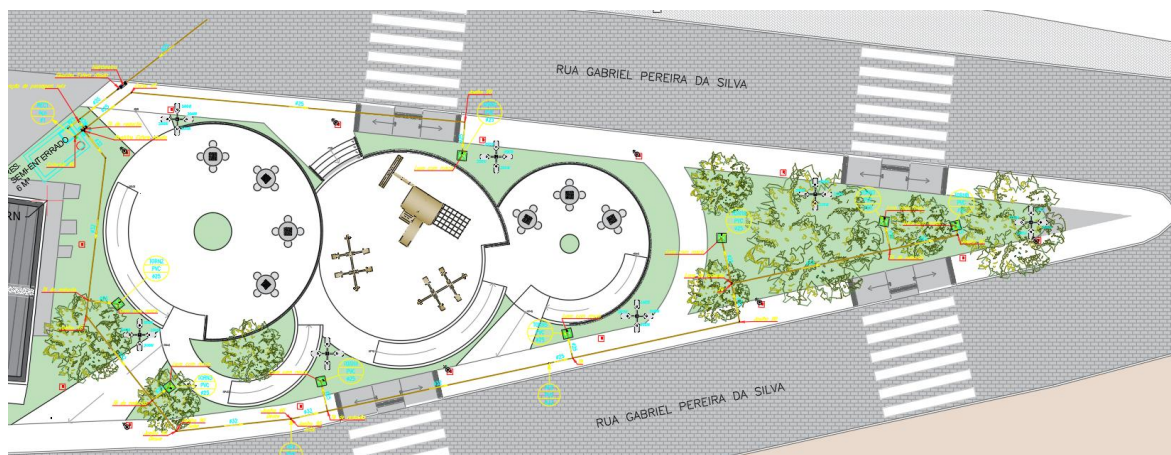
Planta de locação dos ramais no projeto arquitetônico da Praça.
